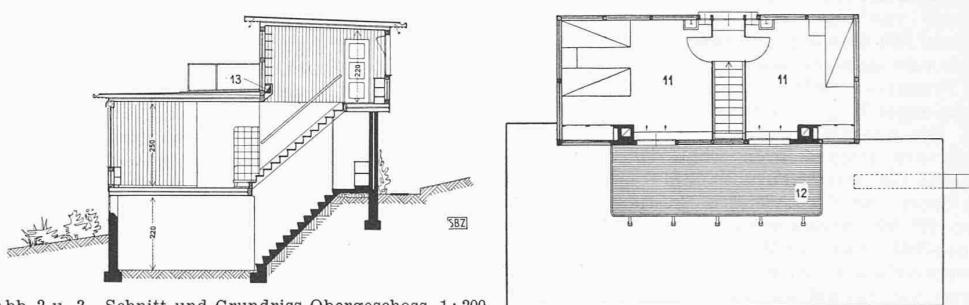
u. 3. Schnitt und Grundriss Obergeschoss, 1:200
